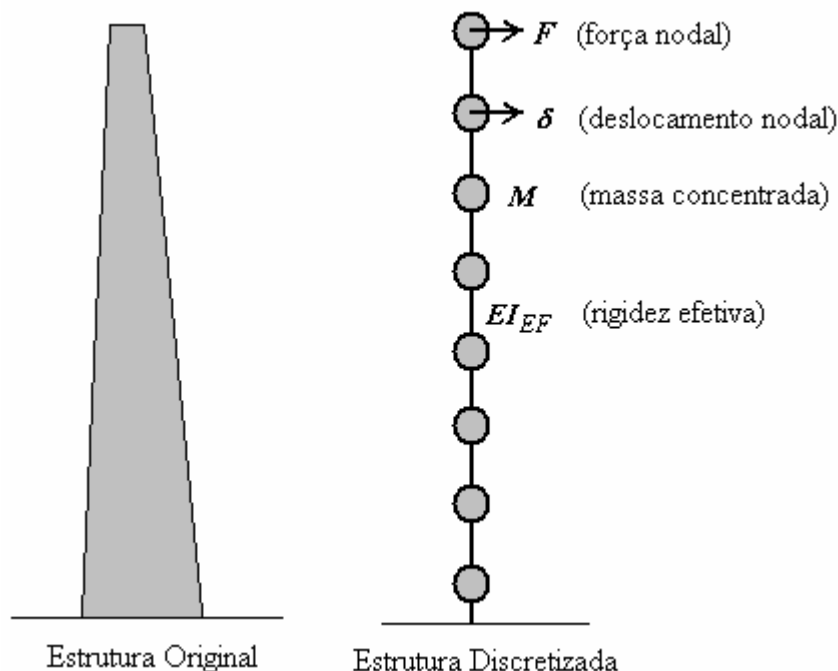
Típica estrutura de telecomunicação em concreto armado
